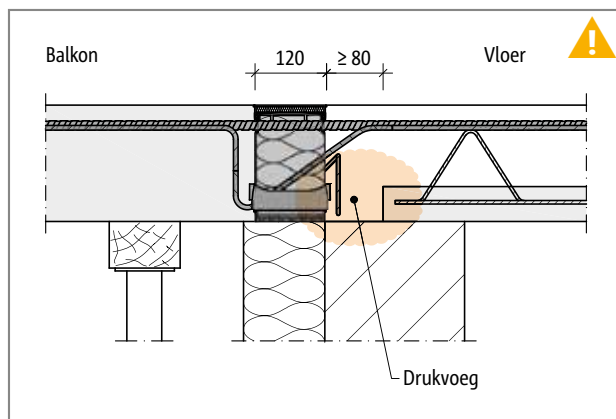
Schöck Isokorb® CXT type K-E: prefabbalkon met verhoogde vloerplaat op een betonnen wand
